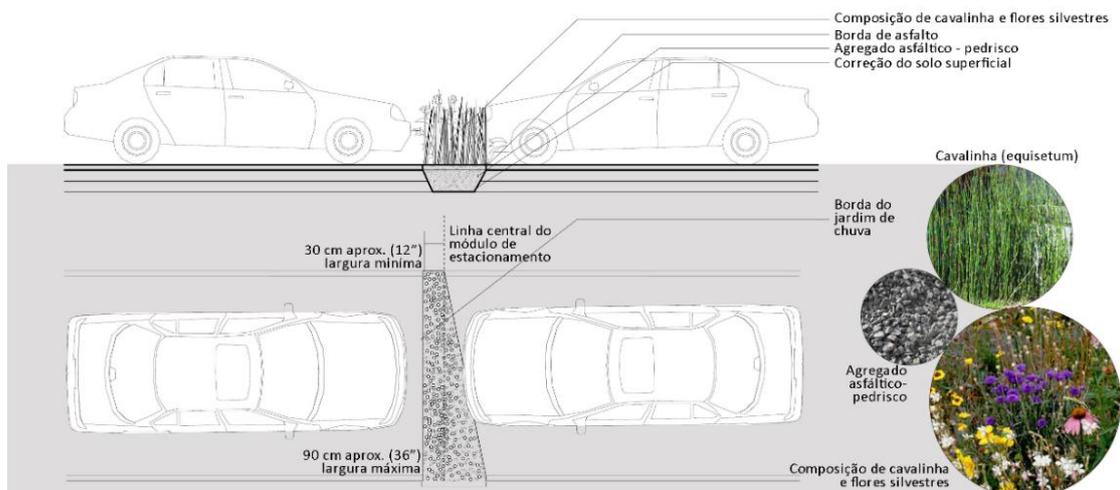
Desenho em planta e elevação, de jardim de chuva inserido em estacionamento jardim. Fonte: UACDC, 2016, p. 58, trabalhada pela autora.
